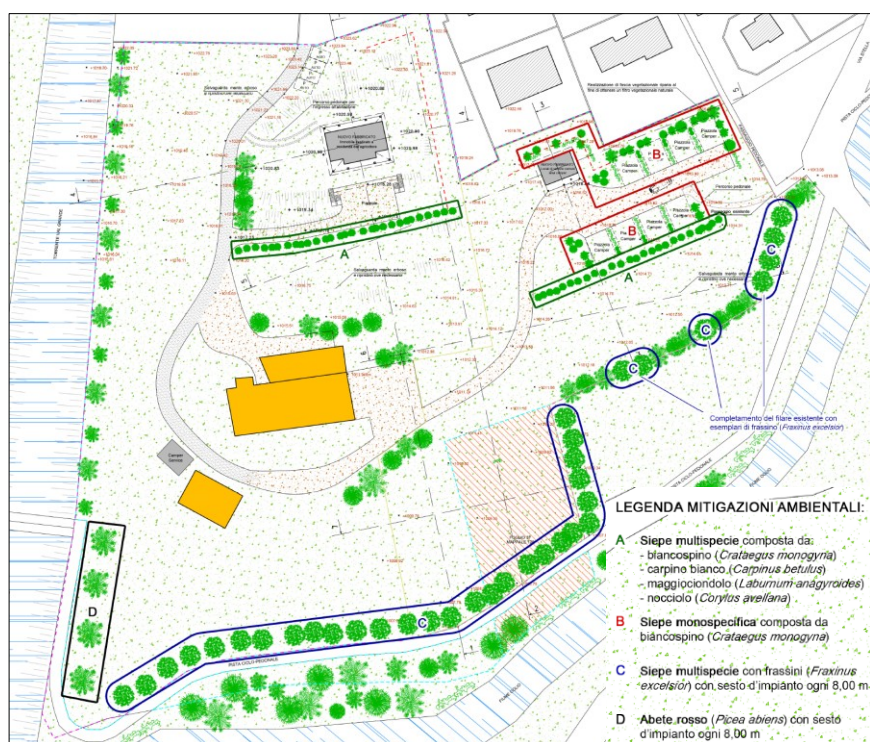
Estratto della tavola 4 "Progetto di mitigazione e compensazione ecologica – Stato di progetto".
